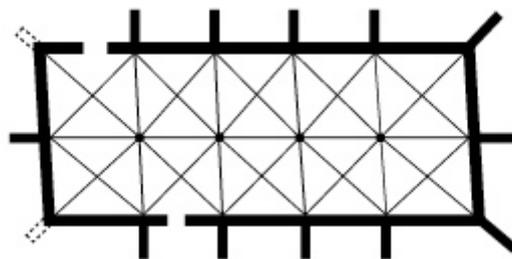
Grundriss von St. Jakob auf der Hülben, Augustiner Chorfrauen, Wien, gegr. Vor 1236
